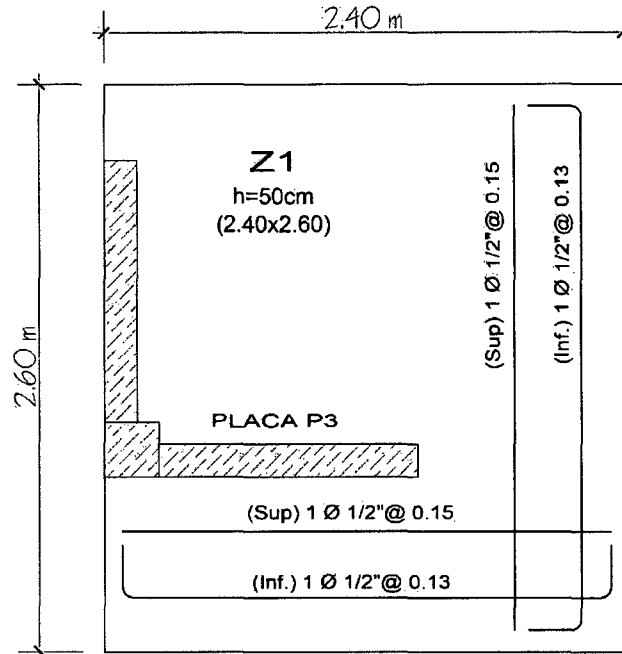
Distribución final del refuerzo para zapata Z-1.
